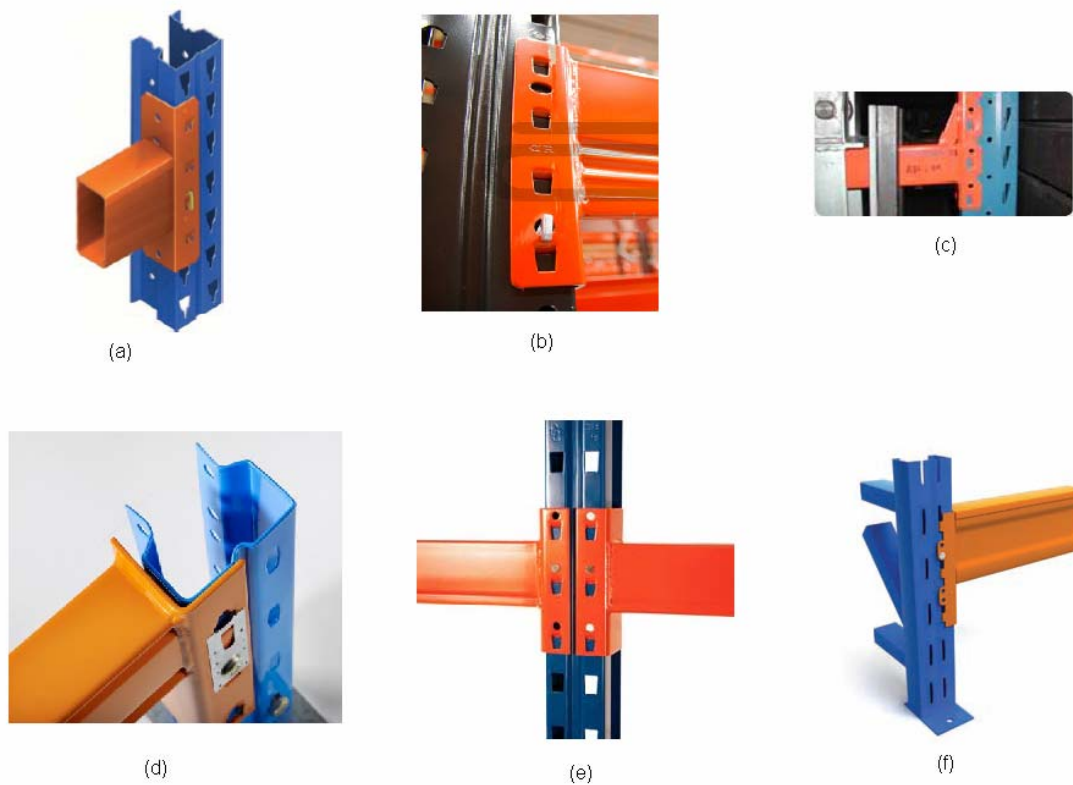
Unions puntal-llarguer de diversos fabricants
